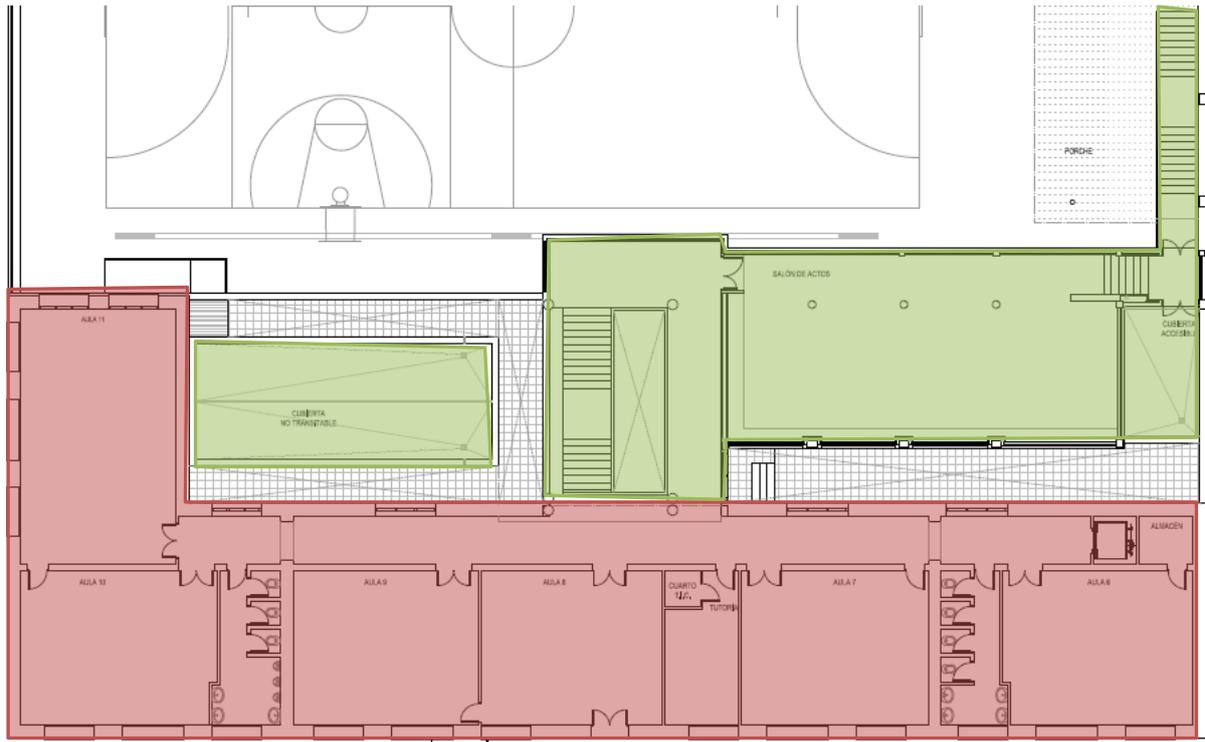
Zonificación de área reformada y área de nueva planta (planta alta)
